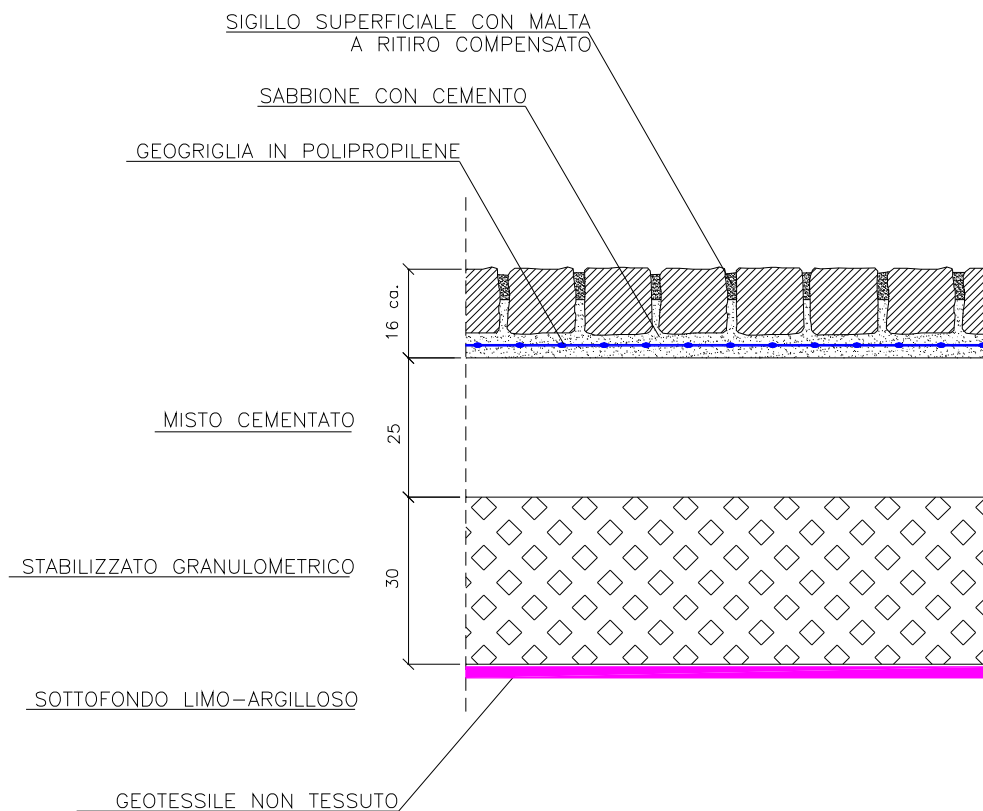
Esempio di pavimentazione ad elementi in porfido
